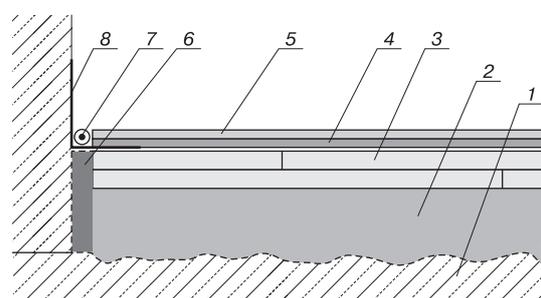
Схема полов сухой сборки: 1 – пленка полиэтиленовая; 2 – выравнивающий слой засыпки; 3 – ГВЛ; 4 – клей плиточный; 5 – плитка керамическая; 6 – лента кромочная; 7 – герметик; 8 – лента гидроизолирующая
